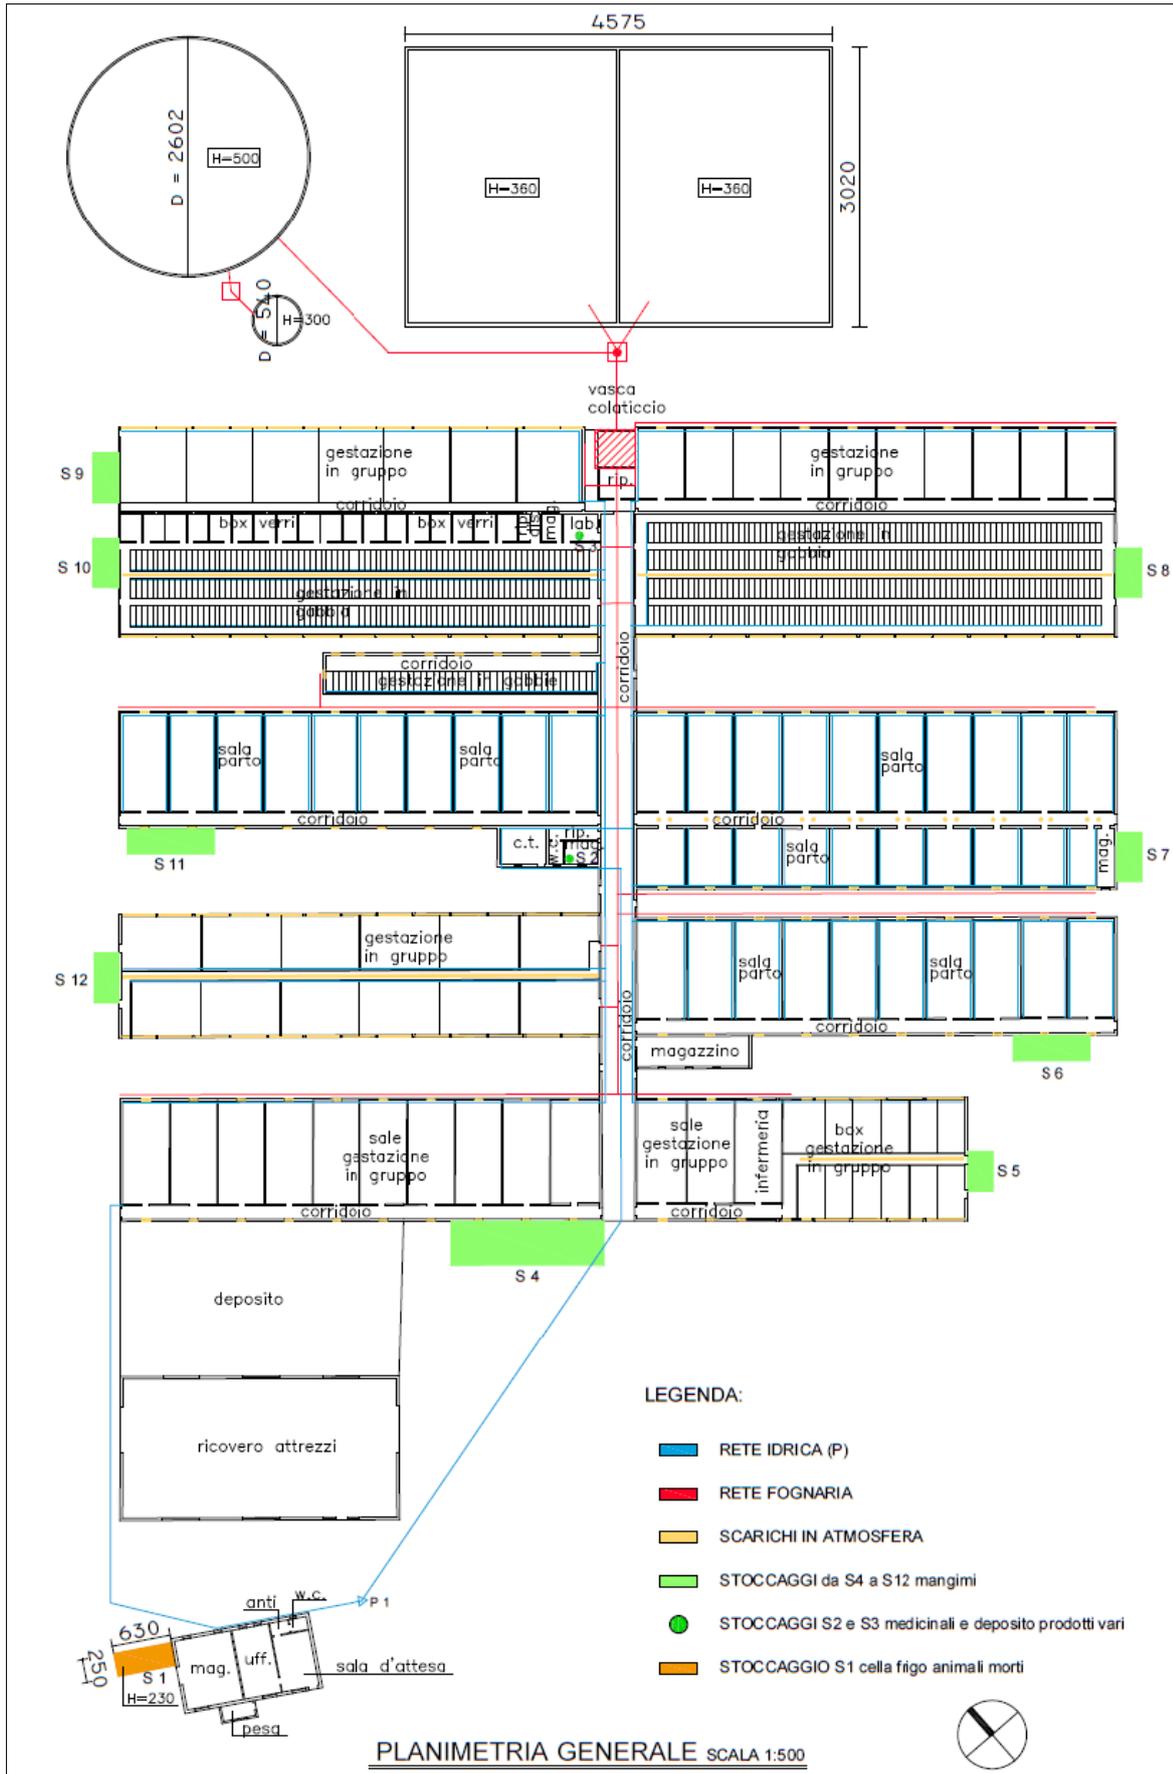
Planimetrie degli impianti (da AIA 2020)
